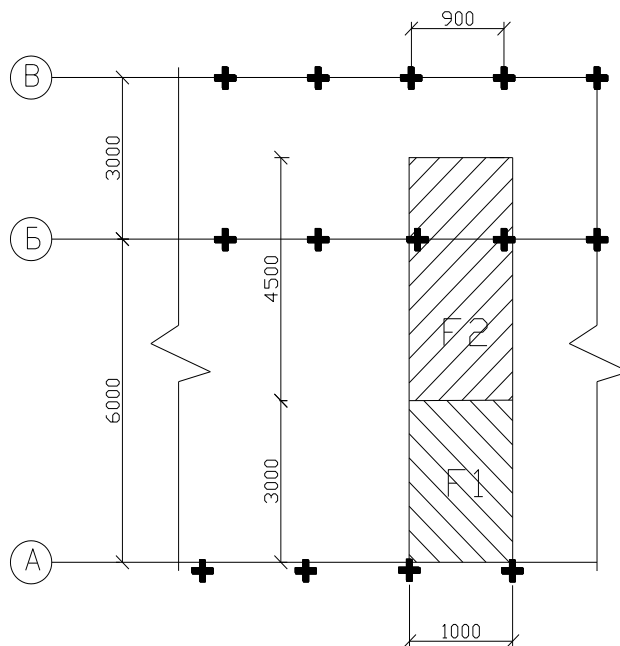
Распределение нагрузок на грузовую площадь
